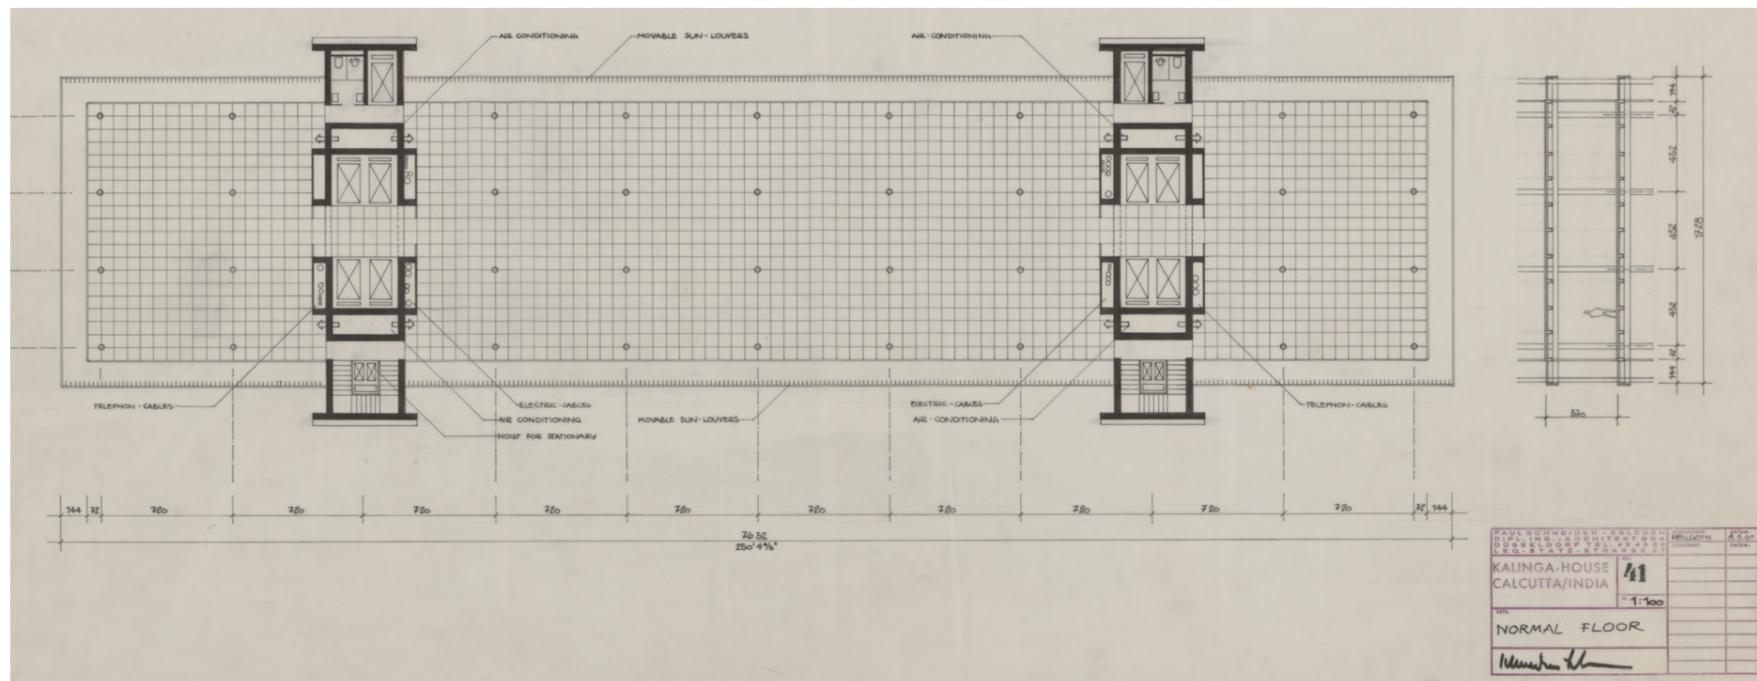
Bürogeschosse mit funktionalen Beschreibungen (Grundriss), Geschossdecken (Schnitt), 1:100, mit Planstempel, 8.5.1961
